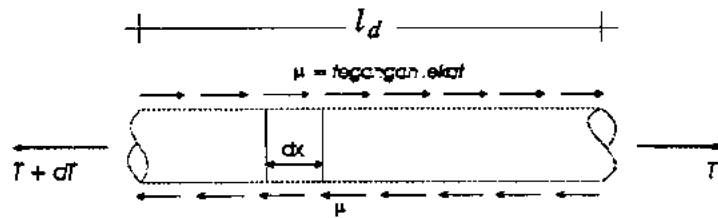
Tahanan geser balok komposit pada profil baja yang seluruhnya ditanam ke dalam beton.
